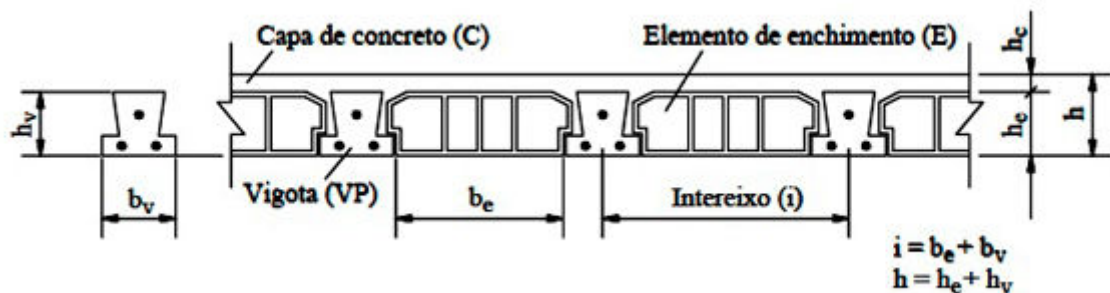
Seção transversal de uma laje com vigotas de concreto protendido
